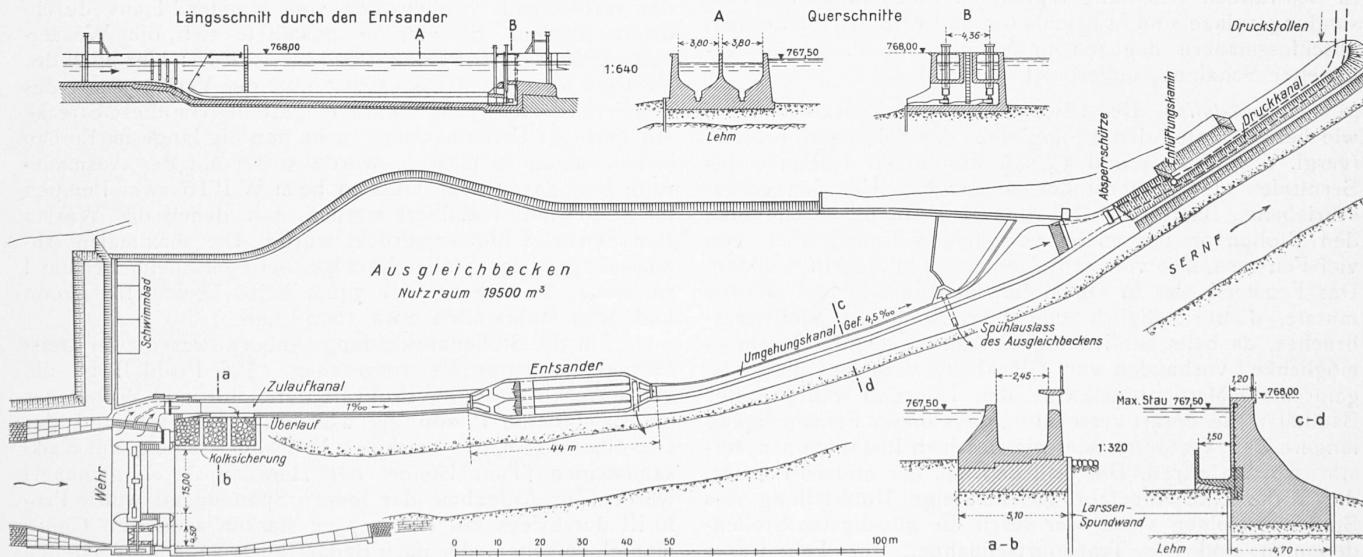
Lageplan (1:1600), sowie Schnitte von Wasserfassung, Ausgleichsbecken, Dufour-Entander und Stolleneinlauf („Druckkanal“).
